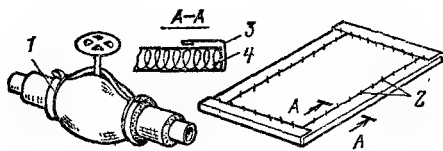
Конструкция тепловой изоляции арматуры минераловатными изделиями в обкладке из стеклоткани.
